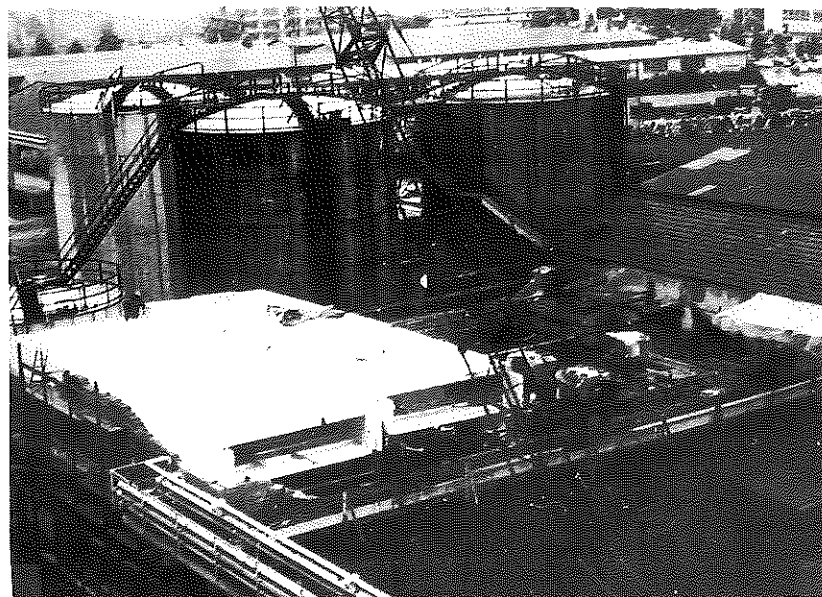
Laje pré-fabricada de madeira aglomerada, em forma de viga caixão, com 16m de vão, Suíça (19) .
